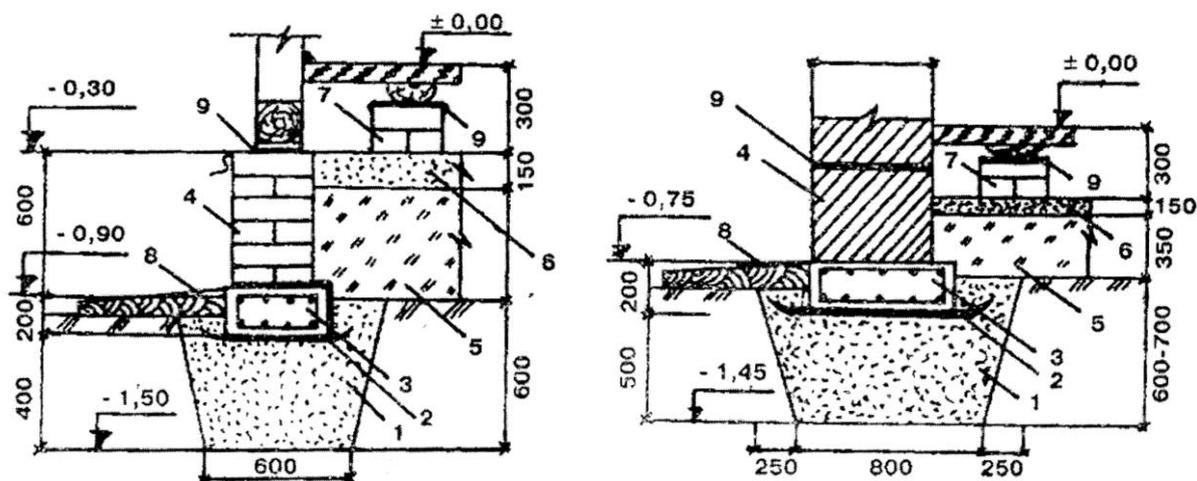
Малозаглубленные ленточные фундаменты: 1 - песчаная подушка; 2 - слой толя; 3 - железобетонная подушка 400х200 мм, 600х200 мм; 4 - цоколь; 5 – насыпной уплотненный грунт; 6 - бетонная подготовка; 7 - кирпичный столбик; 8 - асфальтовая отмостка; 9 – гидроизоляция.
